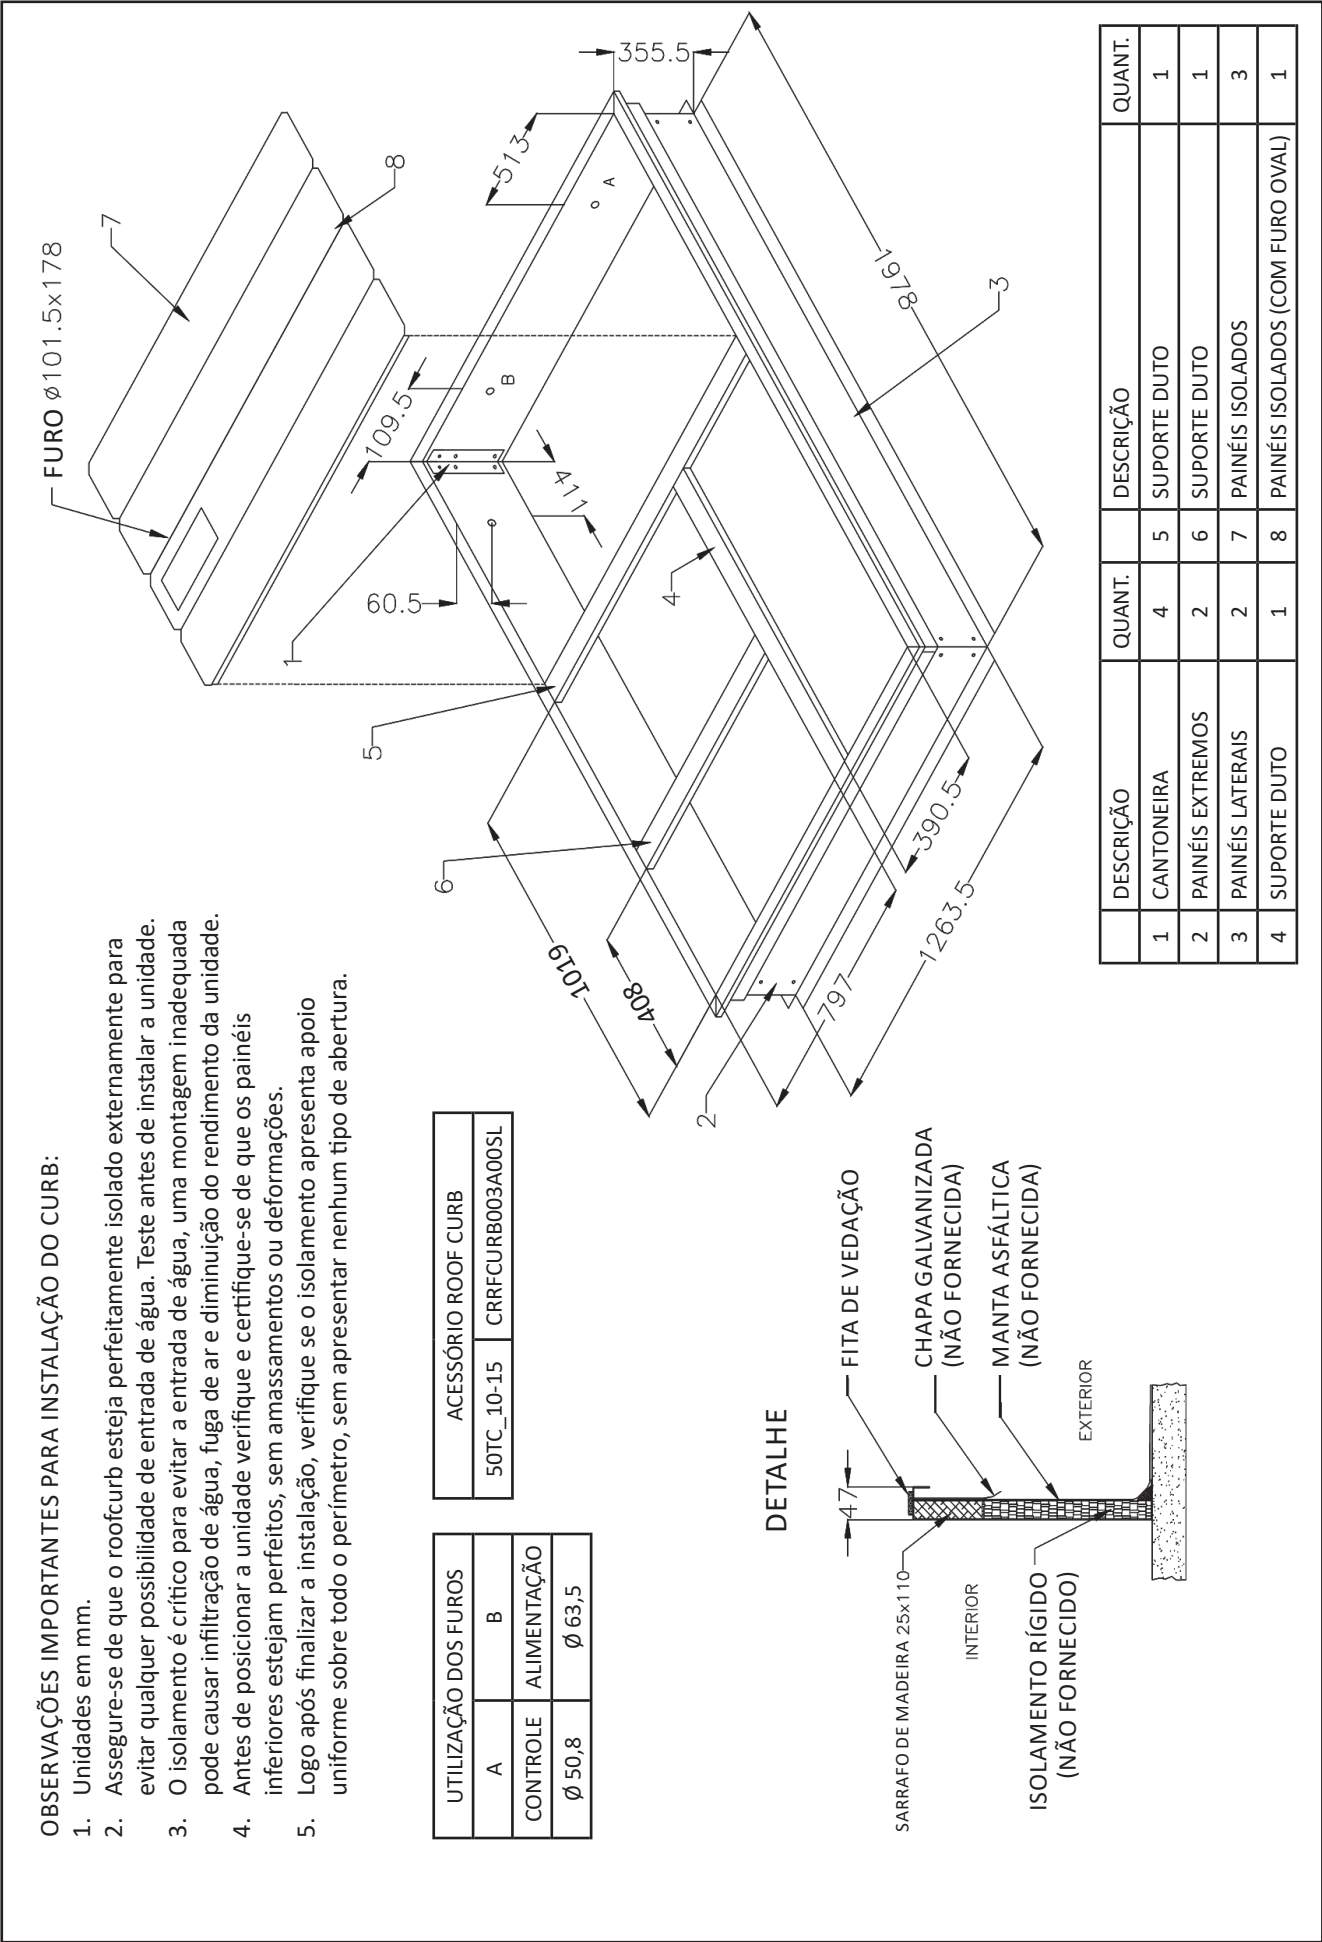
(cont.) - Desenho dimensional da unidade – 50TC_10-15 - Detalhes do Roof Curb
